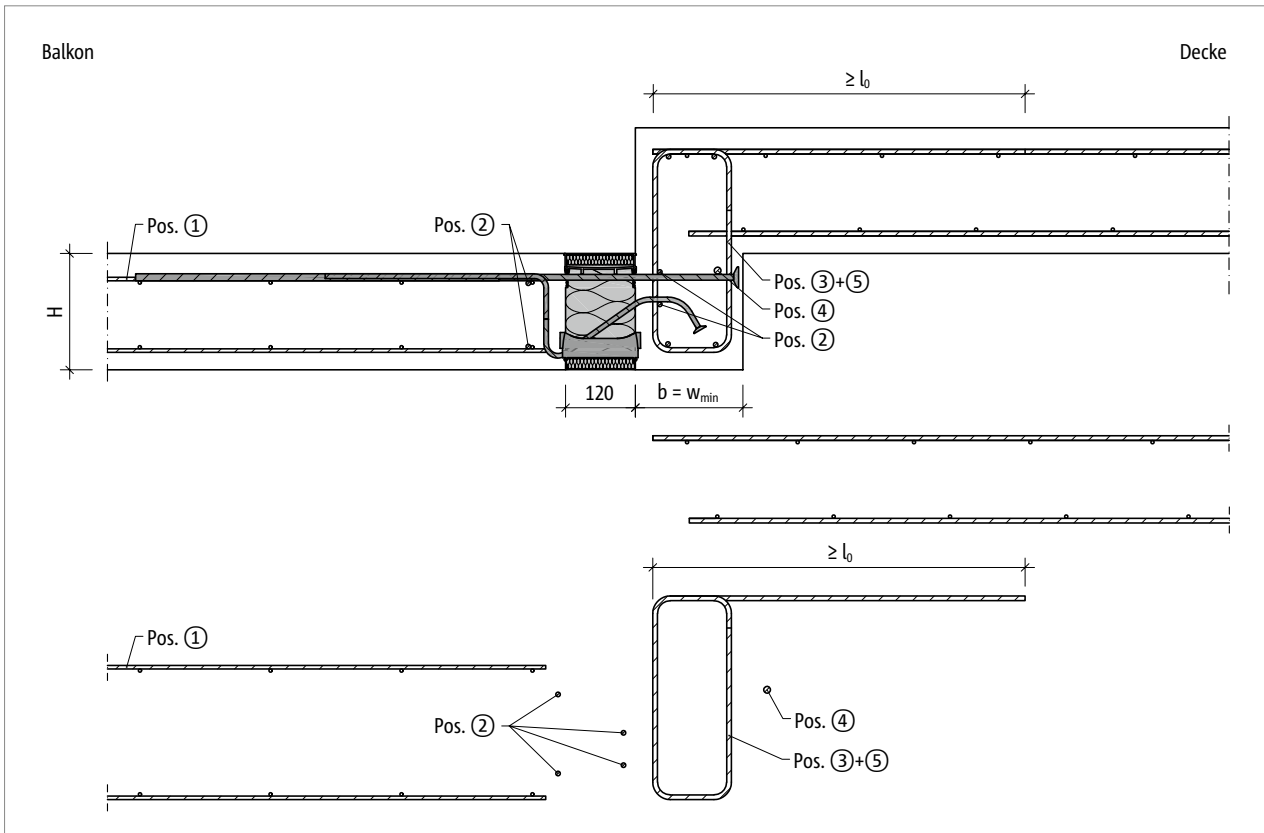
Schöck Isokorb® XT Typ KL-U: Bauseitige Bewehrung für Balkon mit Höhenversatz nach unten mit minimaler Bauteilabmessung ( $w_{vorh} = w_{min}$ )
